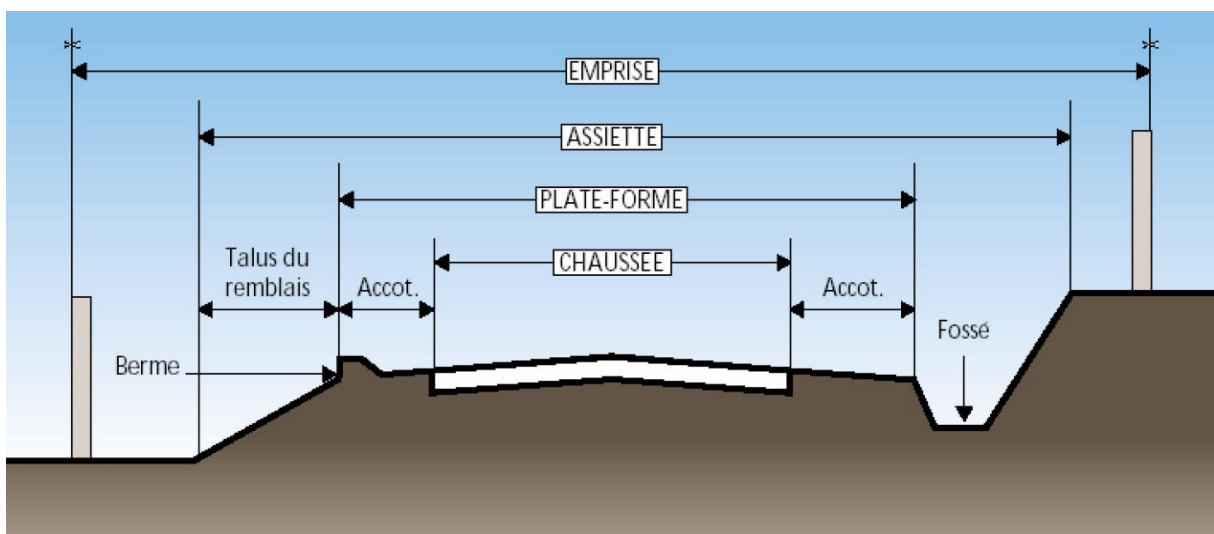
Profil en travers type d'une chaussée [Visa, 2008]
